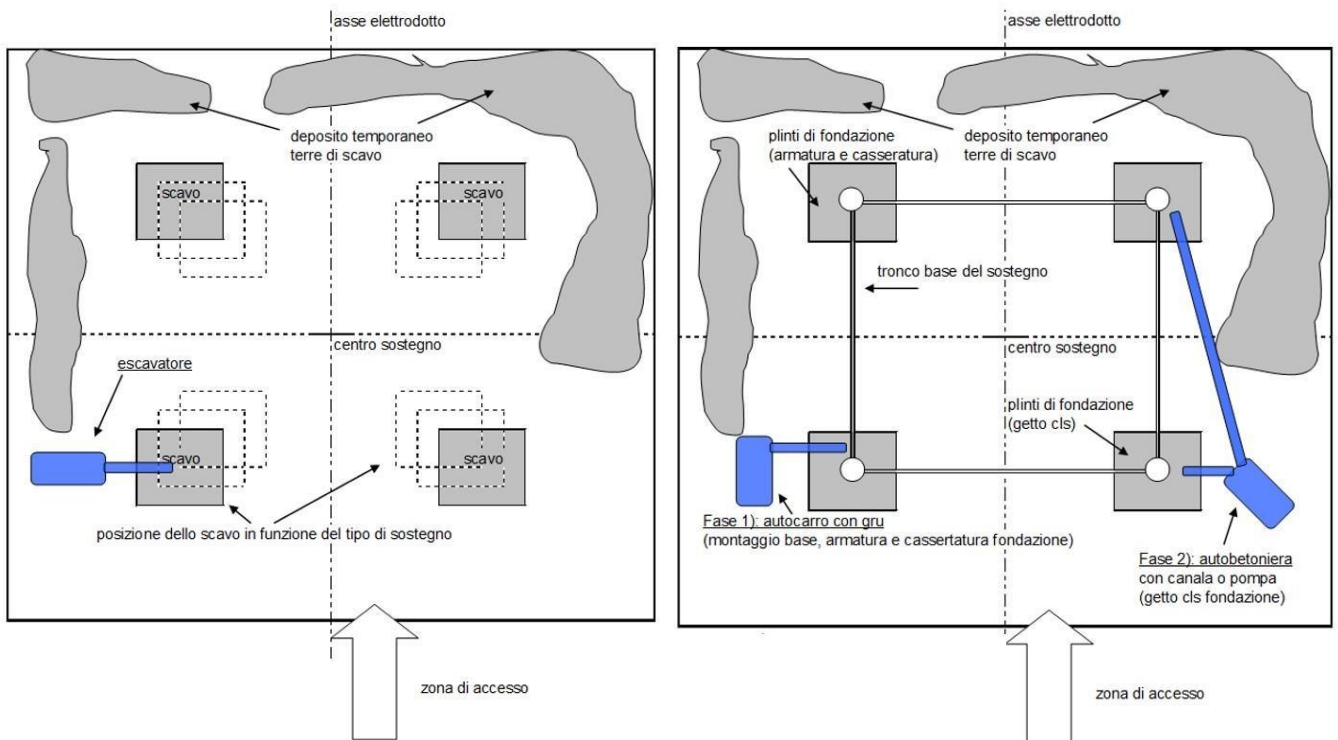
Planimetria dell'Area Sostegno (scavo di fondazione - getto e basi) – Tipologico
